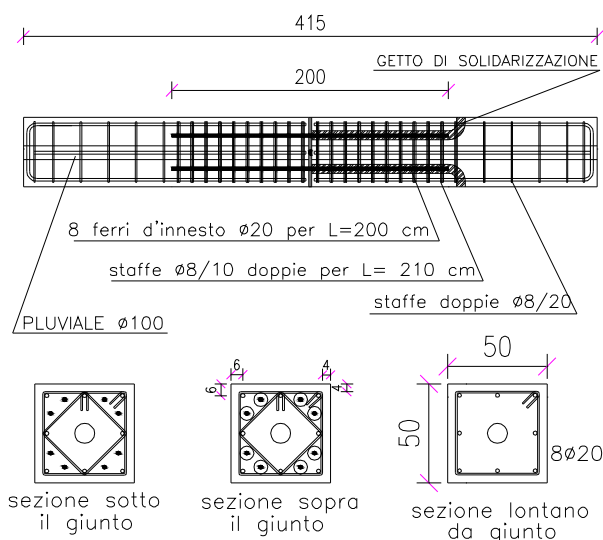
Disposizione delle armature negli elementi sottoposti alle prove di carico.
